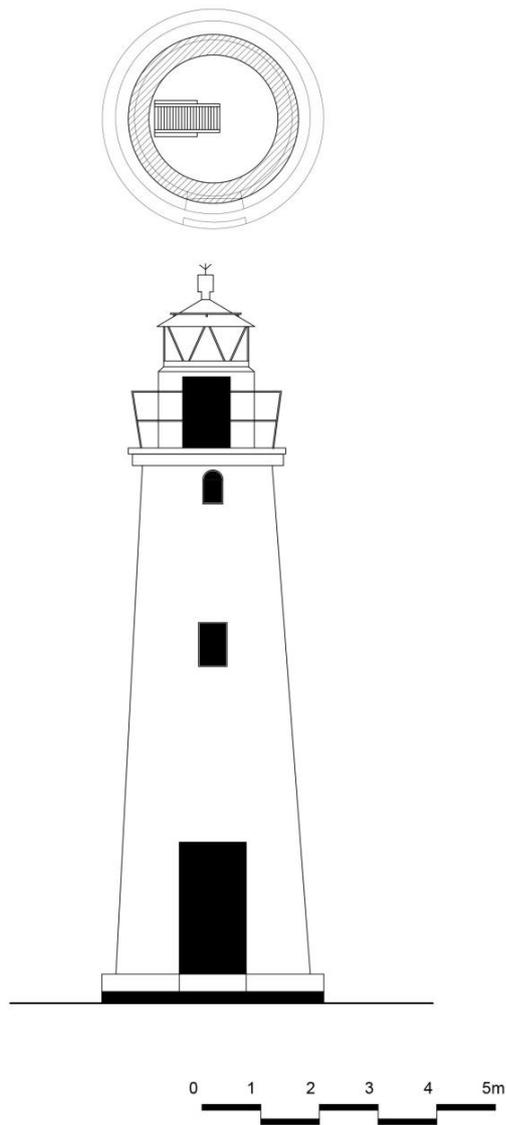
Rielaborazione della pianta e del prospetto del faro di Porto Maurizio (IM).
